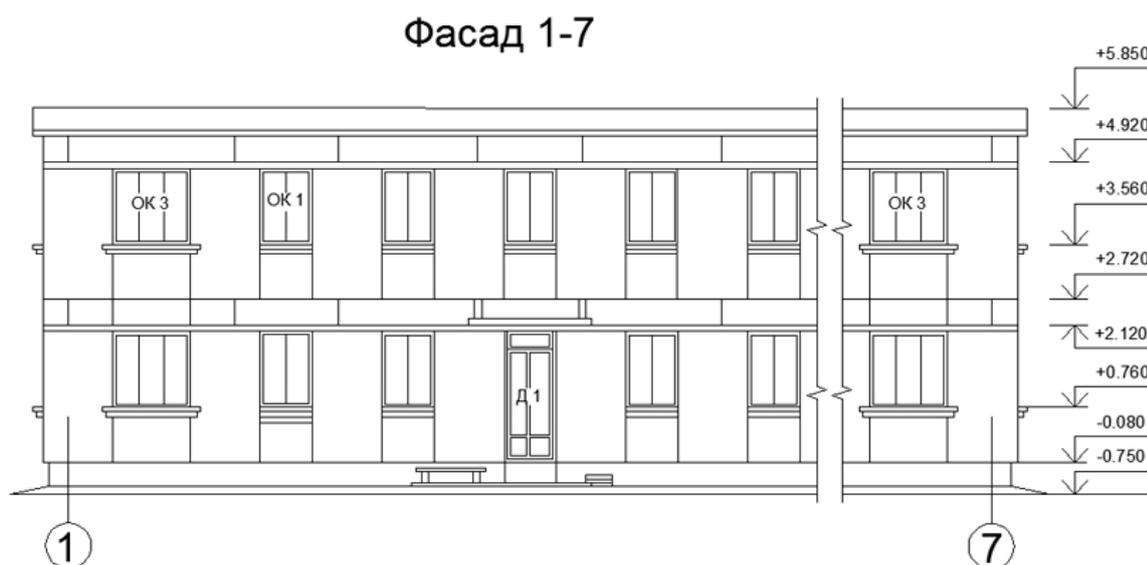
Фасад 1-7 крупноблочного жилого дома
